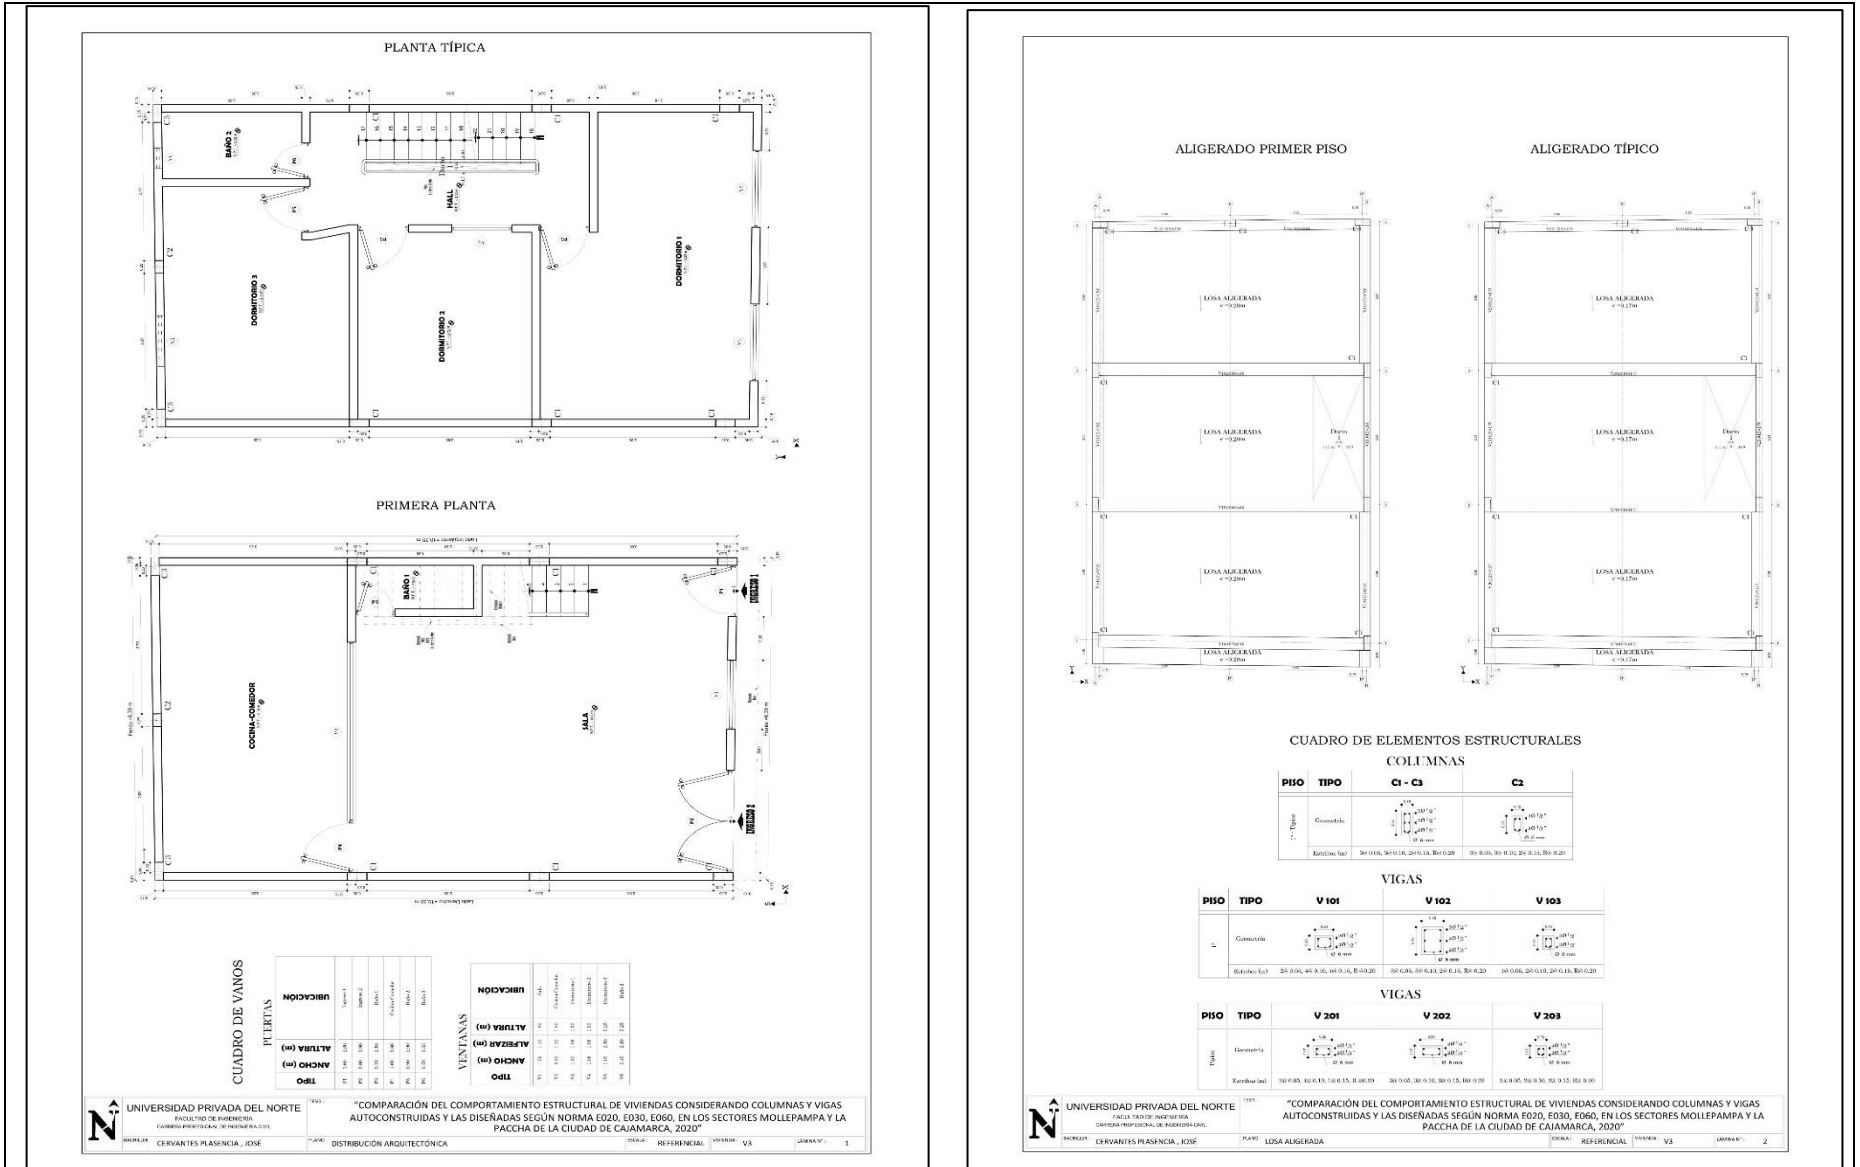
Planos de arquitectura y losa aligerada vivienda 3
